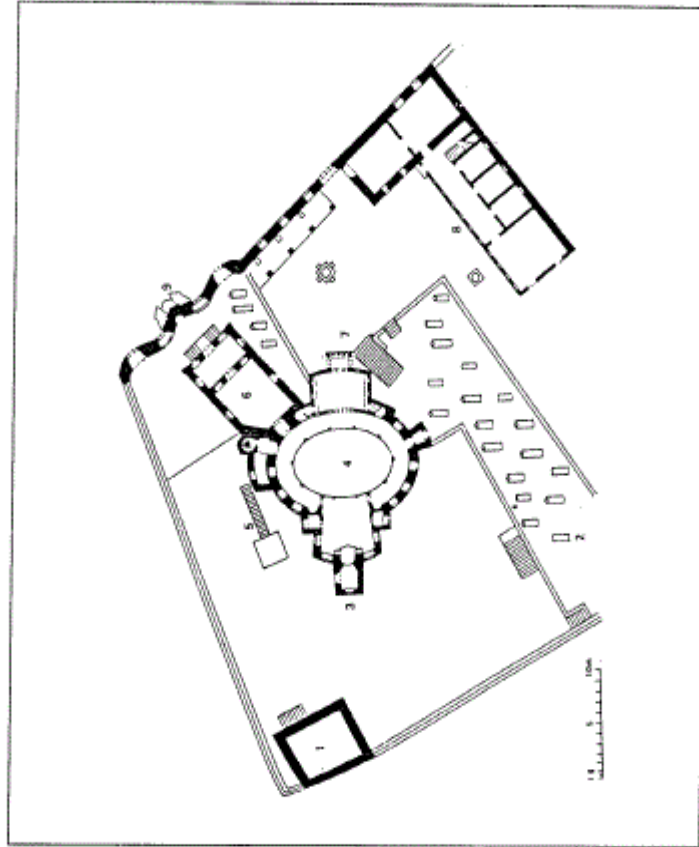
مسقط أفقي لمسجد ومدرسة زال محمود باشا ضمن مجمعه (كلية) في
